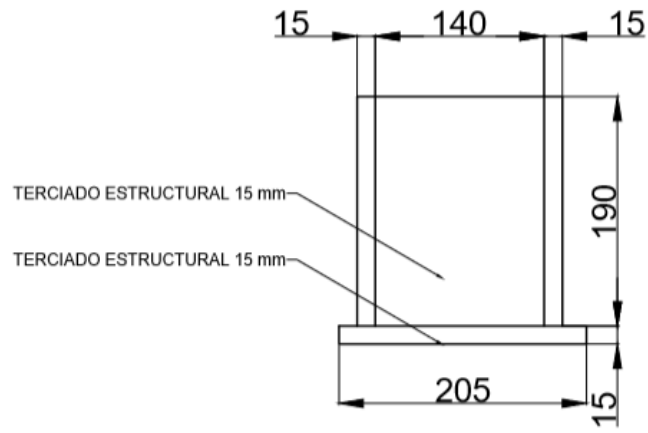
Diseño moldaje del bloque con eco-ladrillo, vista lateral.
